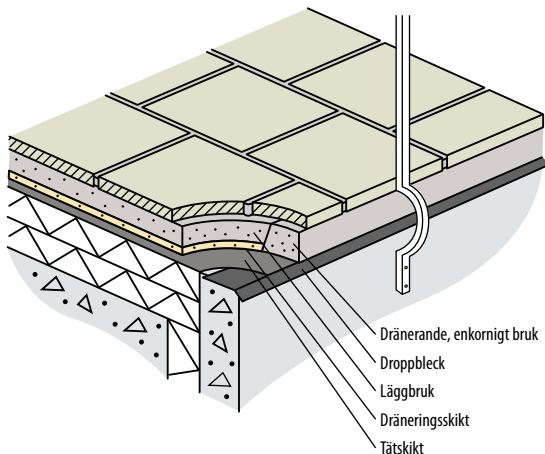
Typkonstruktion AT. Uppbyggnad av altan på betongbjälklag.
